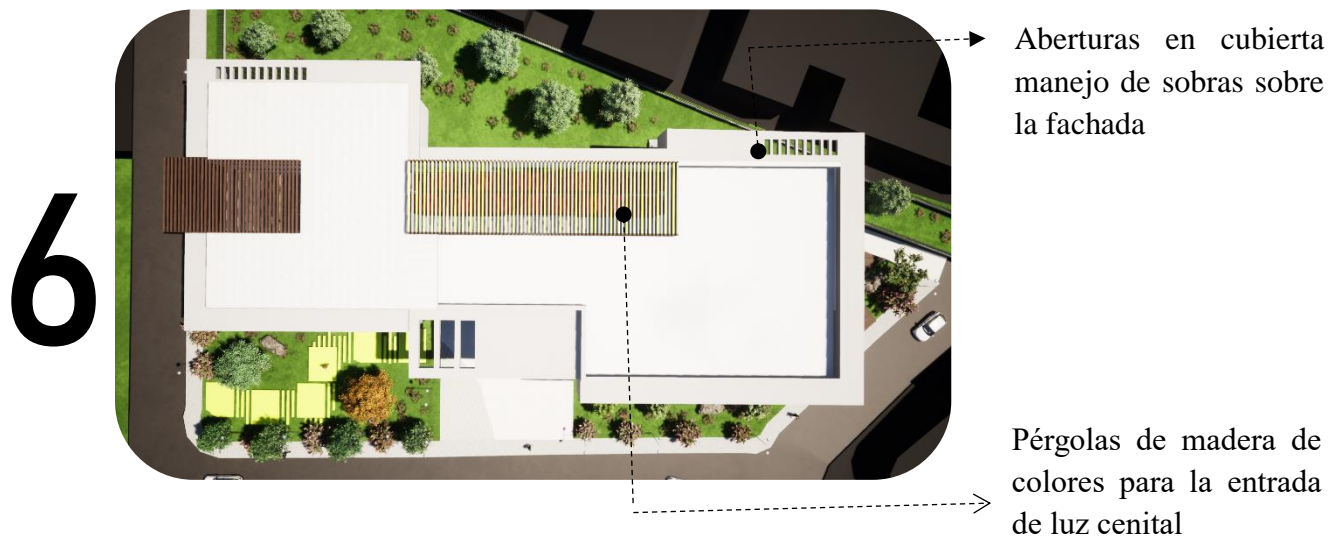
propuesta planta cubierta. (Autoría: Propia).
